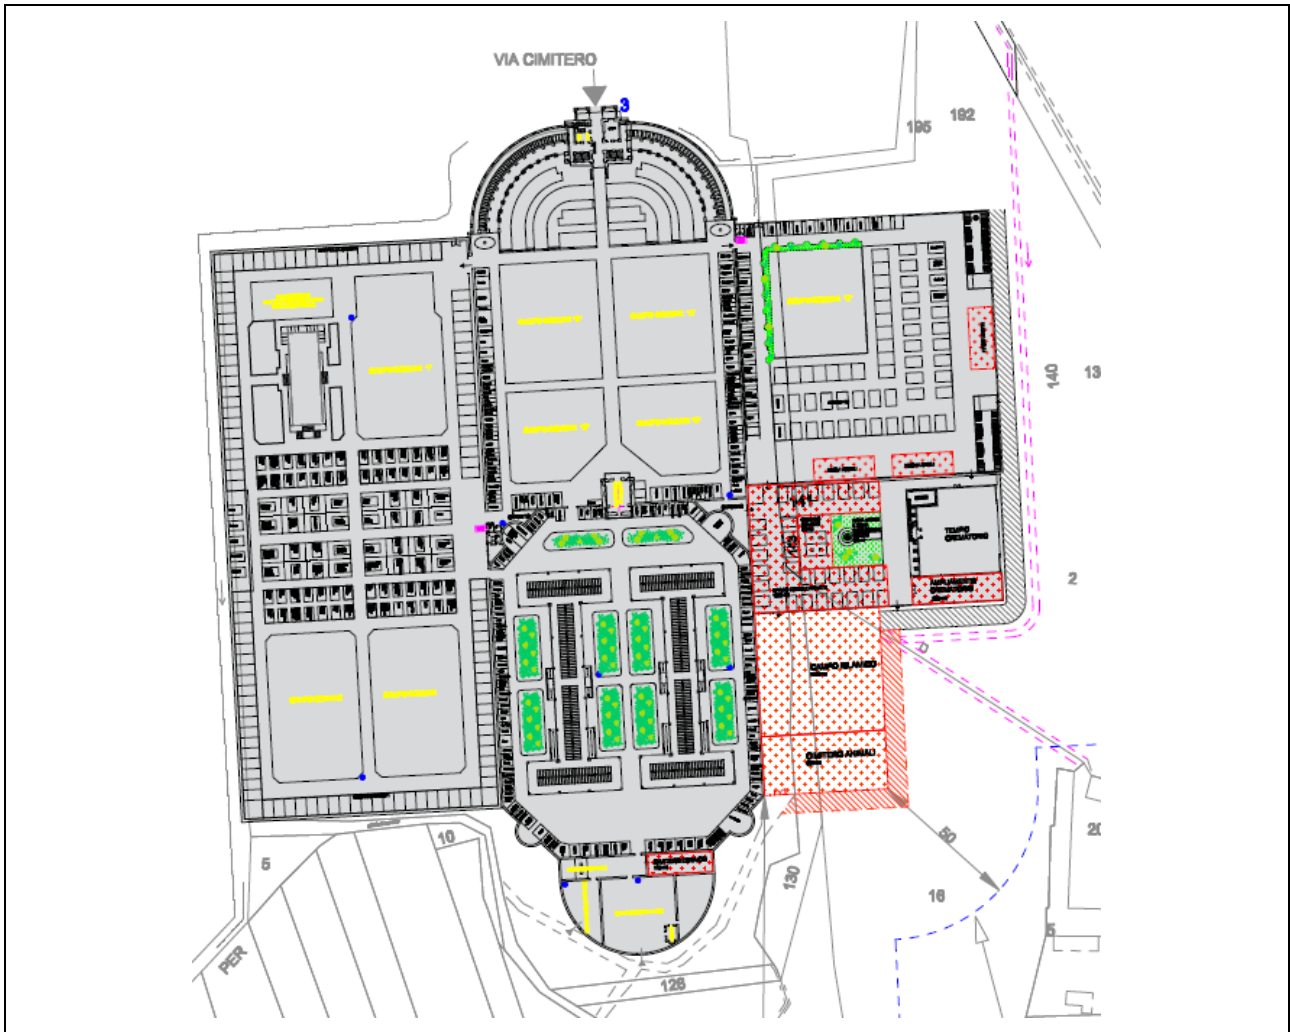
stralcio planimetrico impianto di cremazione – VARIANTE (non approvata allo stato attuale)
